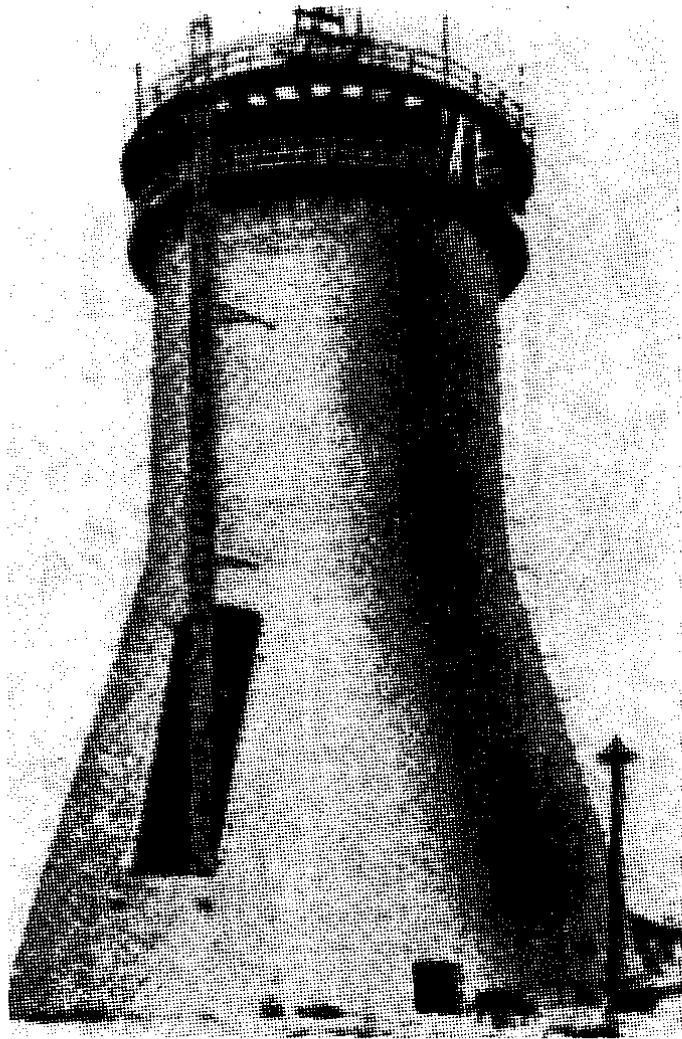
正在施工中的300米高钢筋混凝土烟囱筒座部分
